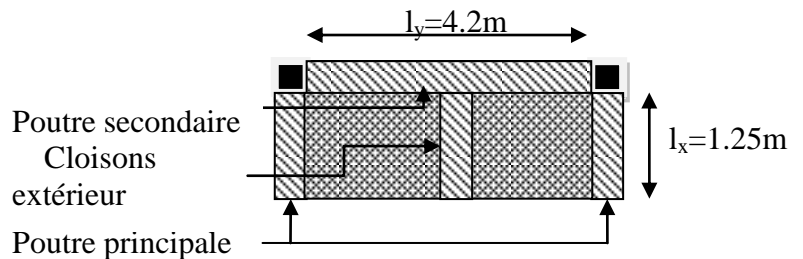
1^{er} type de Balcon sur trois appuis
